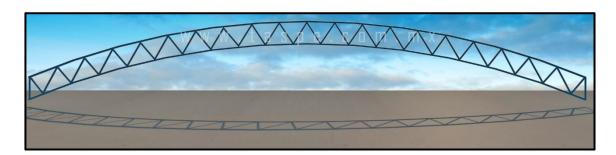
Esquema Ejemplo de la Estructura Metálica para Techo Curvo
